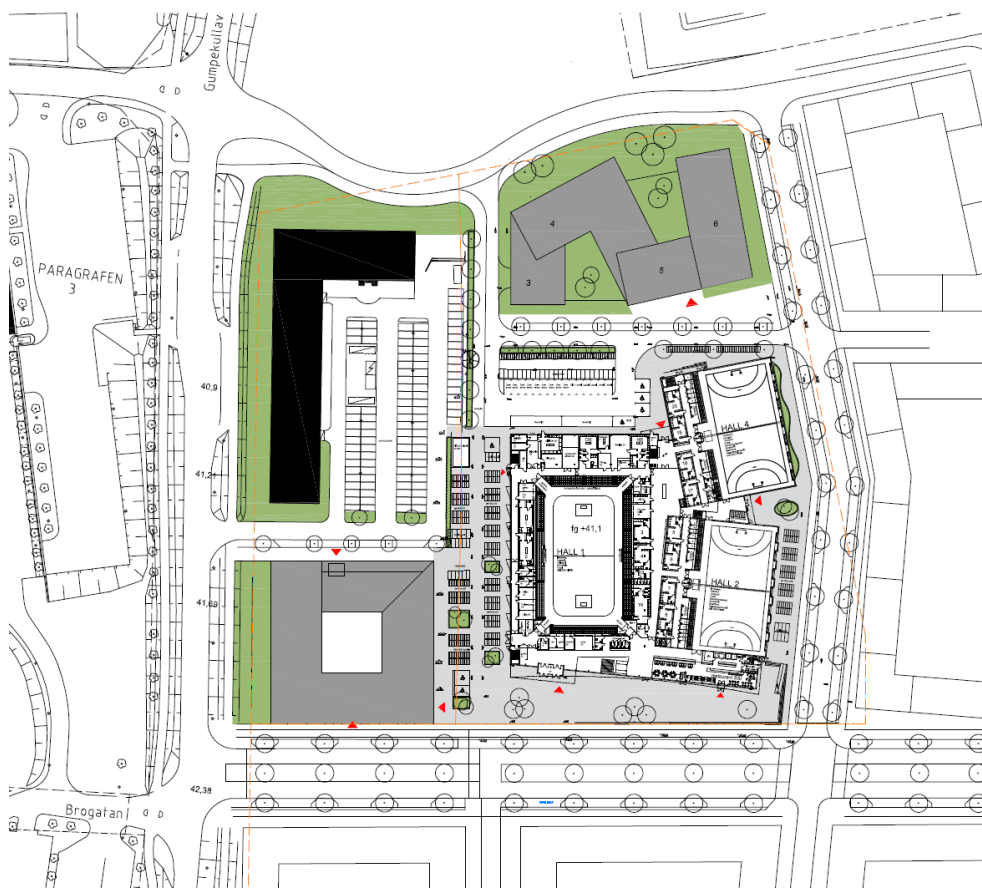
Situationsplan som visar hur den färdiga multihallen (hall 1-5) skulle kunna se ut och hur den möter en tänkt framtida stadsstruktur (Situationsplan, Tengbom).
